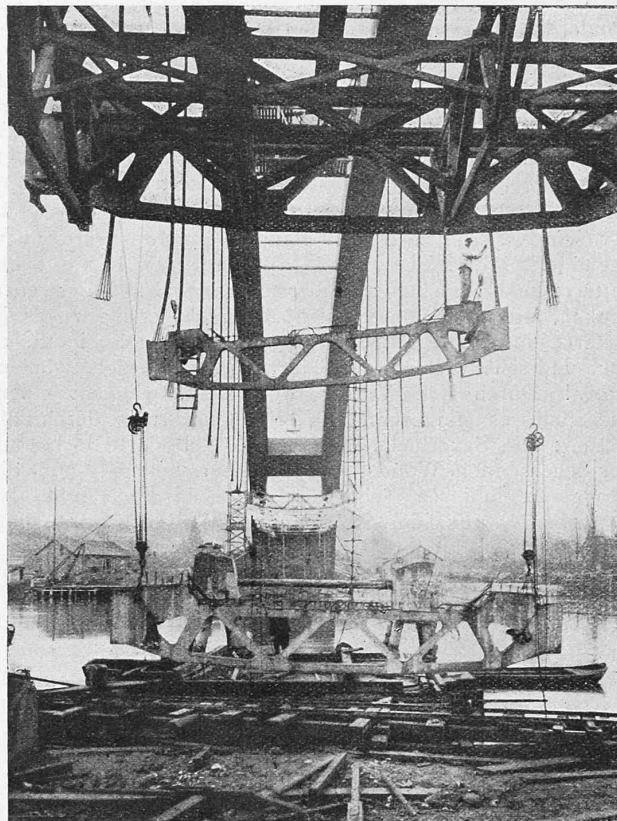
Einbau der Eisenbeton-Querträger für die Fahrbahn.
